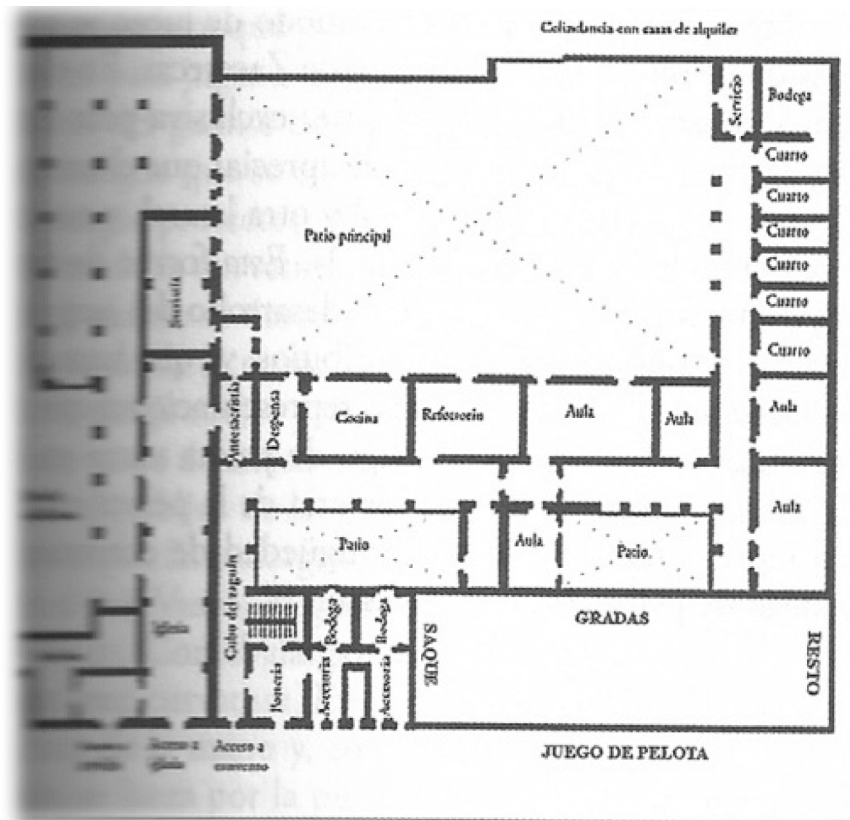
Planta baja del convento en donde se hallaba el frontón.
